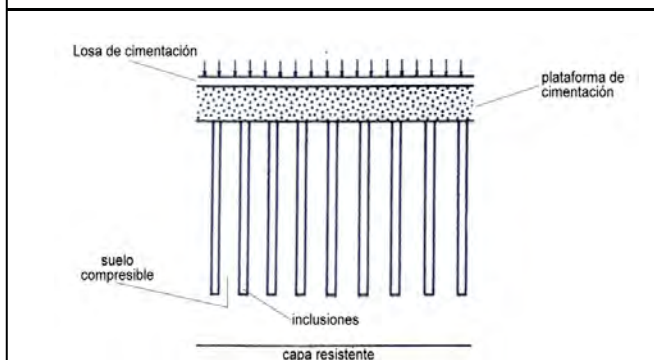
ESQUEMA CONSTRUCTIVO DE UNA CIMENTACIÓN CON INCLUSIONES Y LOSA DE CONCRETO ARMADO
